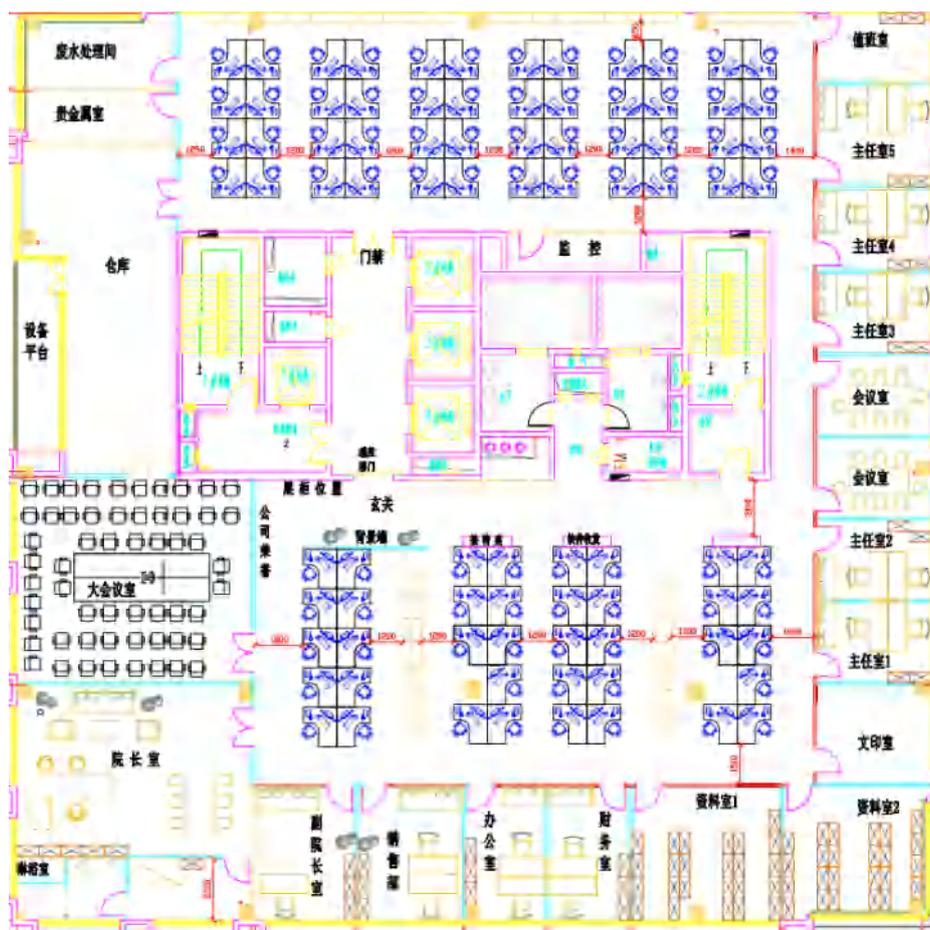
本项目 13 层平面布置图 (详见附图 2.1)
